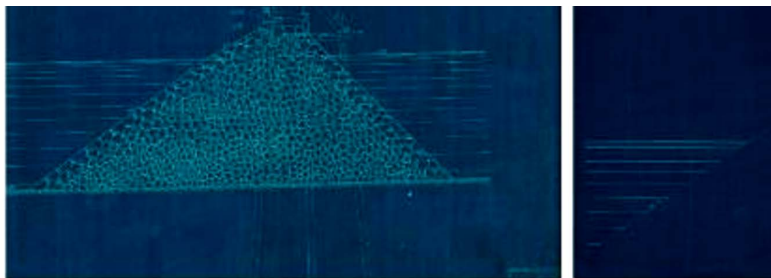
Escolleras Detalles. Fuente: Planos históricos CGPLP.
